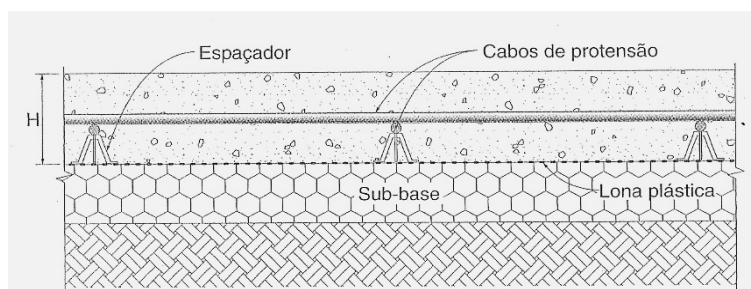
Seção tipo: Pavimento de concreto protendido (Rodrigues et al., 2006)
